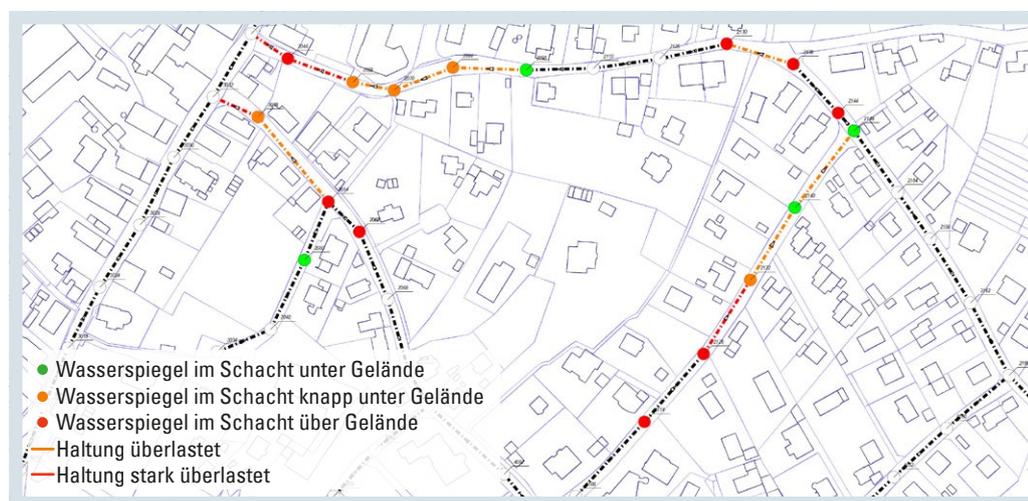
Lageplan mit überlasteten Schächten und Haltungen
